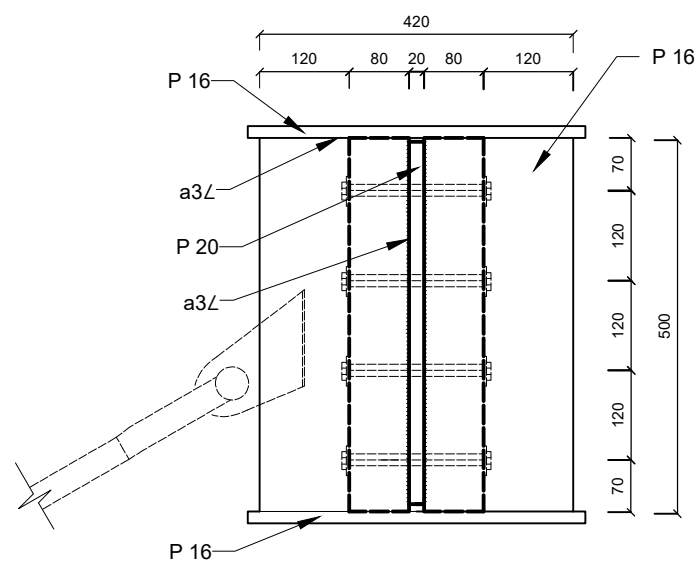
VRCHOLOVÝ STYČNÍK
